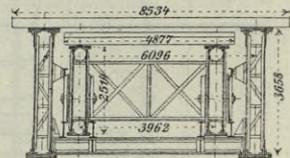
(links). Kurvenführung an der festen Brücke zur Senkung des Mittelteiles vor dem Zurückrollen.
